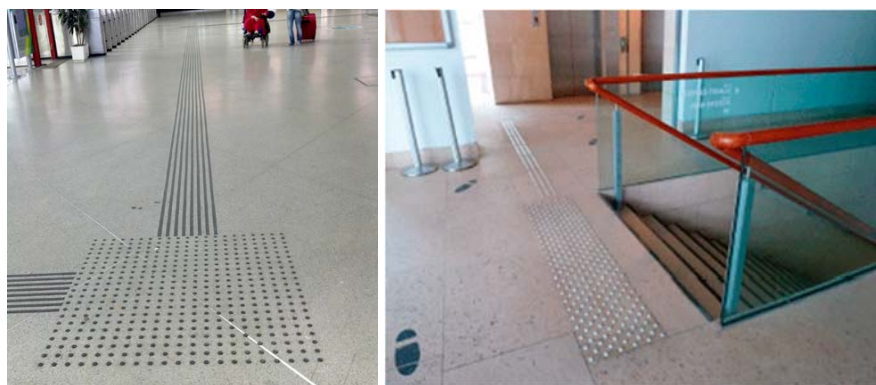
Ejemplos de implantación de pavimentos táctiles indicadores.
